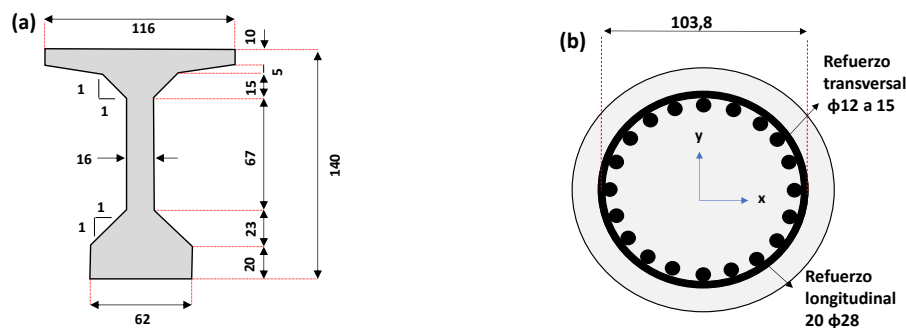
(a) Esquema vigas postensadas (en cm). (b) Sección transversal de las columnas (en mm).
